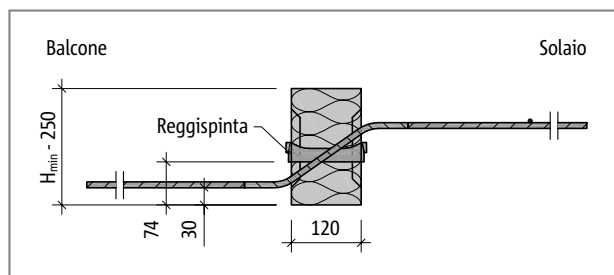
Schöck Isokorb® tipo da QXT70 a QXT90: sezione dell'elemento
